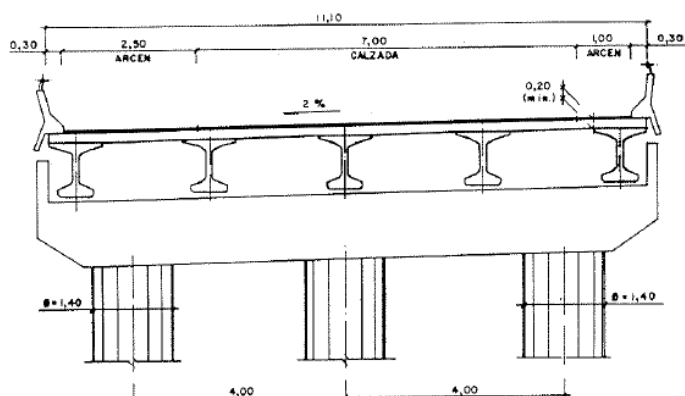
Sección transversal del tablero de la calzada sentido Murcia
